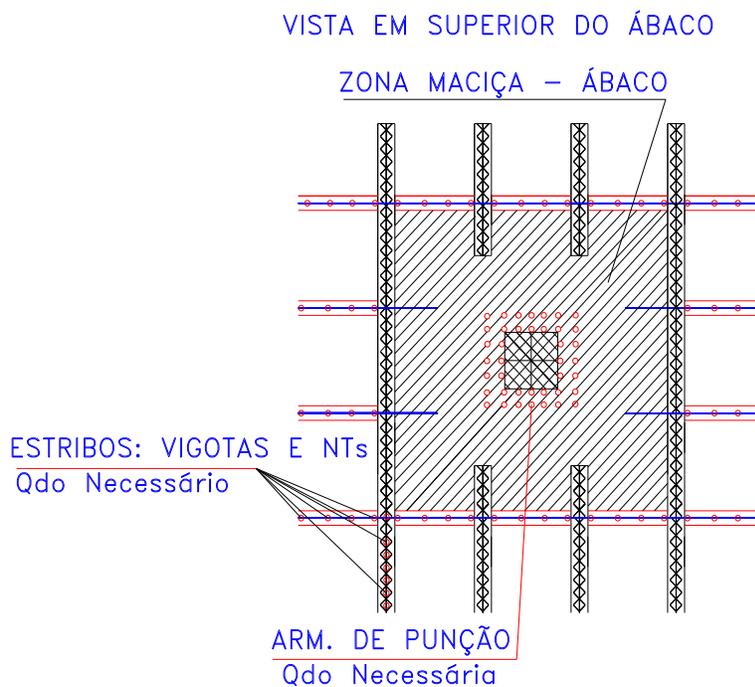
Vista em Planta do Ábaco. Fonte: arquivo do autor.
